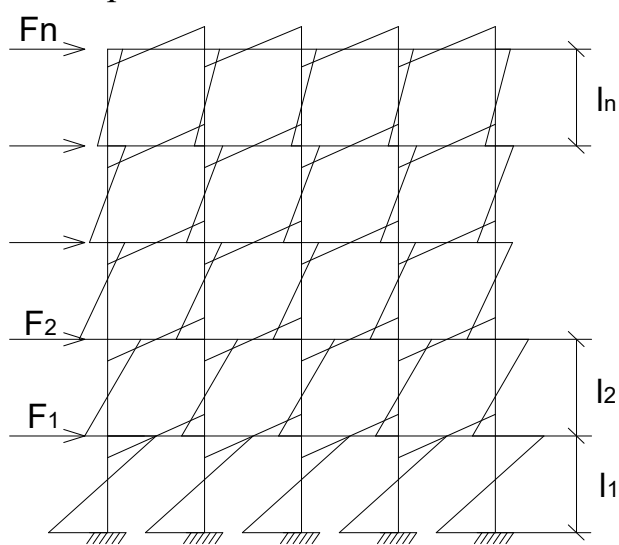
К расчету многоэтажных рам на горизонтальные нагрузки
